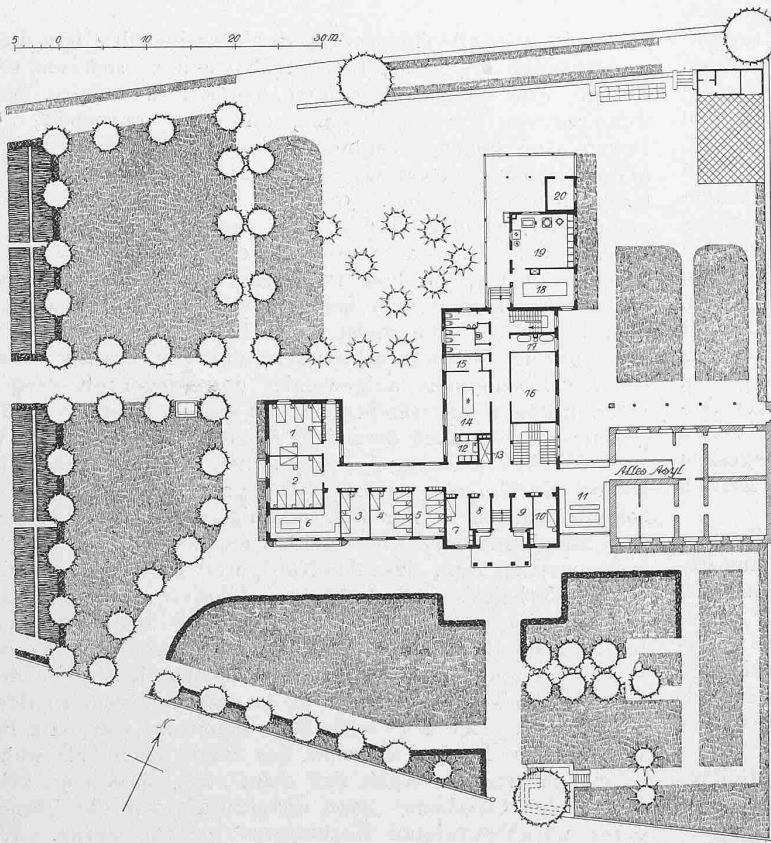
Asyl «Gottesgnad» in Mett bei Biel. — Erdgeschoss mit Lageplan 1 : 800.
